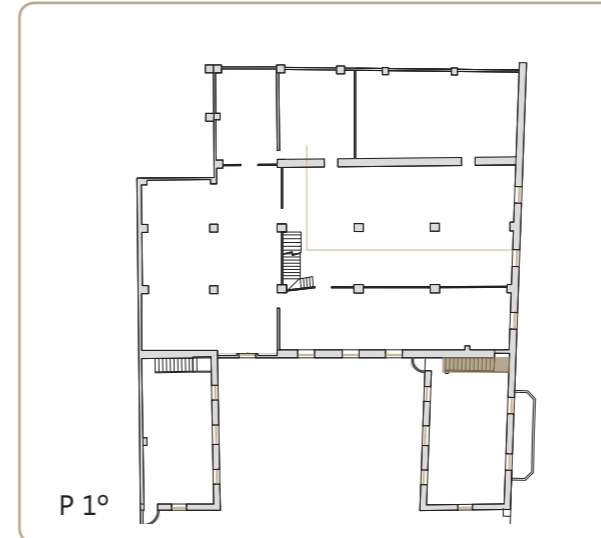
(Izquierda) Detalle de la escalera entre PB y 1º piso de nave lateral derecha de fachada.
